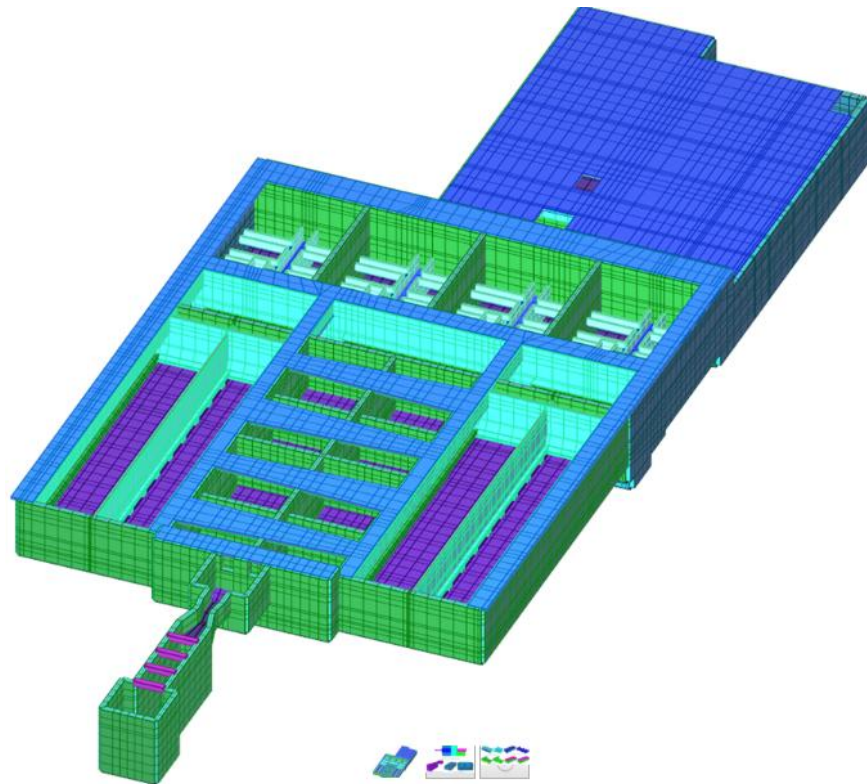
Diseño Planta de Tratamiento El Pórtico (Cúcuta)
